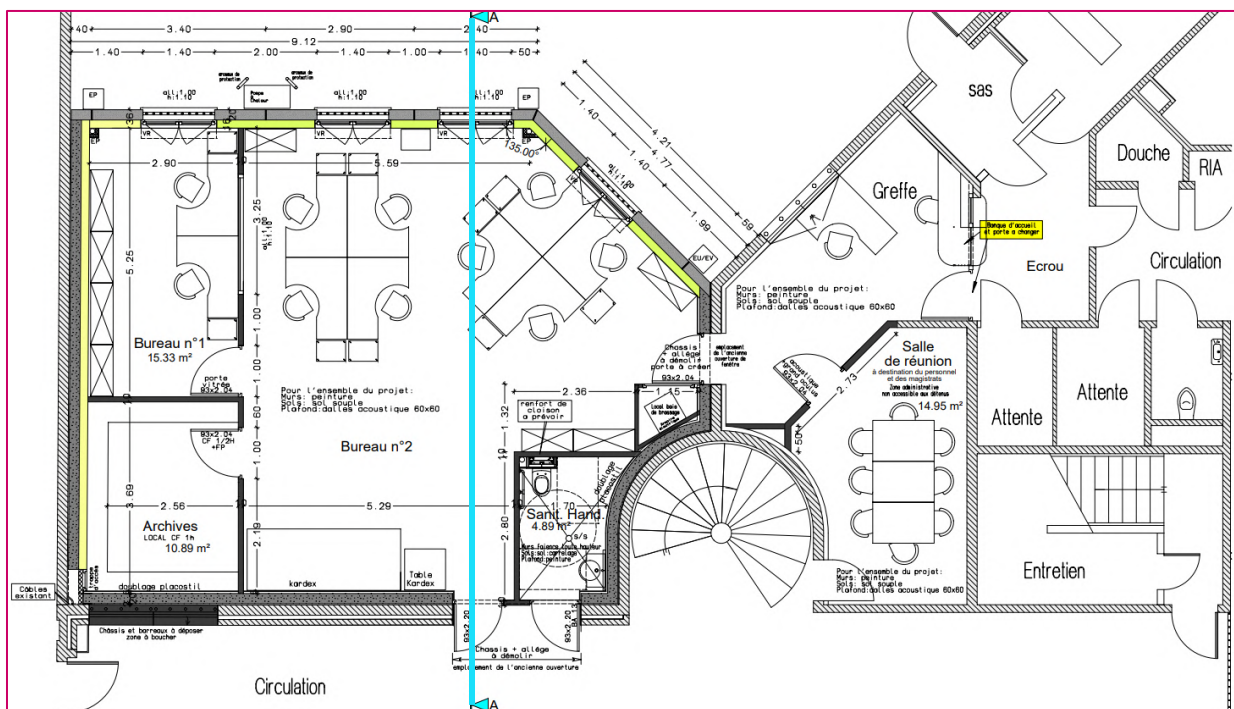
Plan projet sans échelle, (Plan projet, B.A.U. Architectes)
